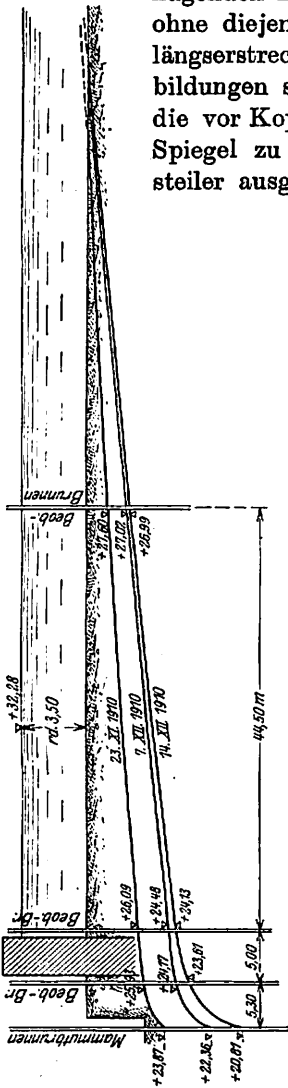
Spreetunnel Inselbrücke (Abschnitt I); beobachtete Spiegelsenkung längs Stromstrich (nach Enzweiler).
